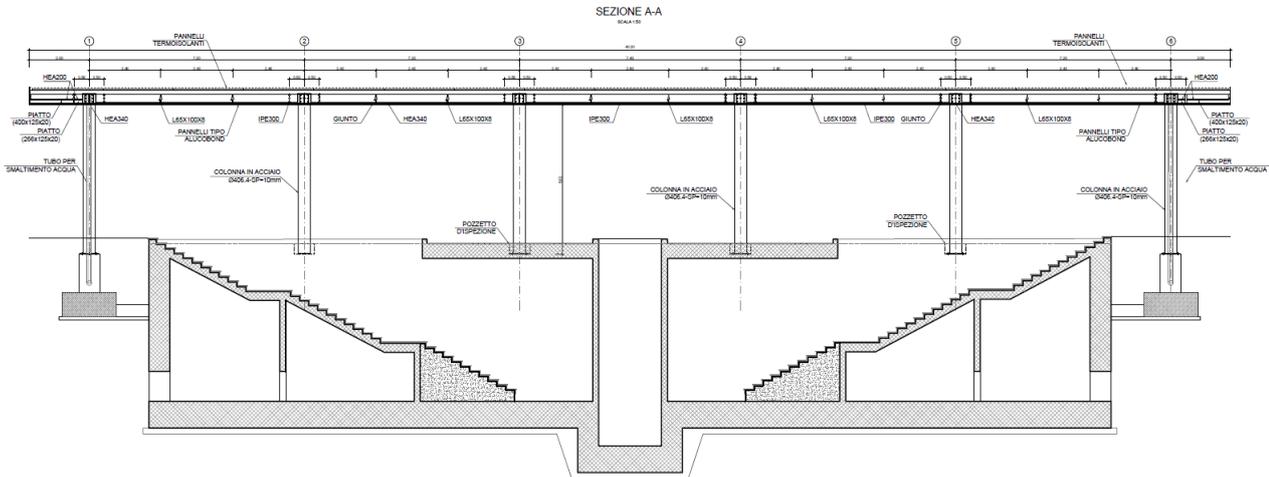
Pensilina fabbricato Tecnologico nella stazione di Ellera: sezione longitudinale
